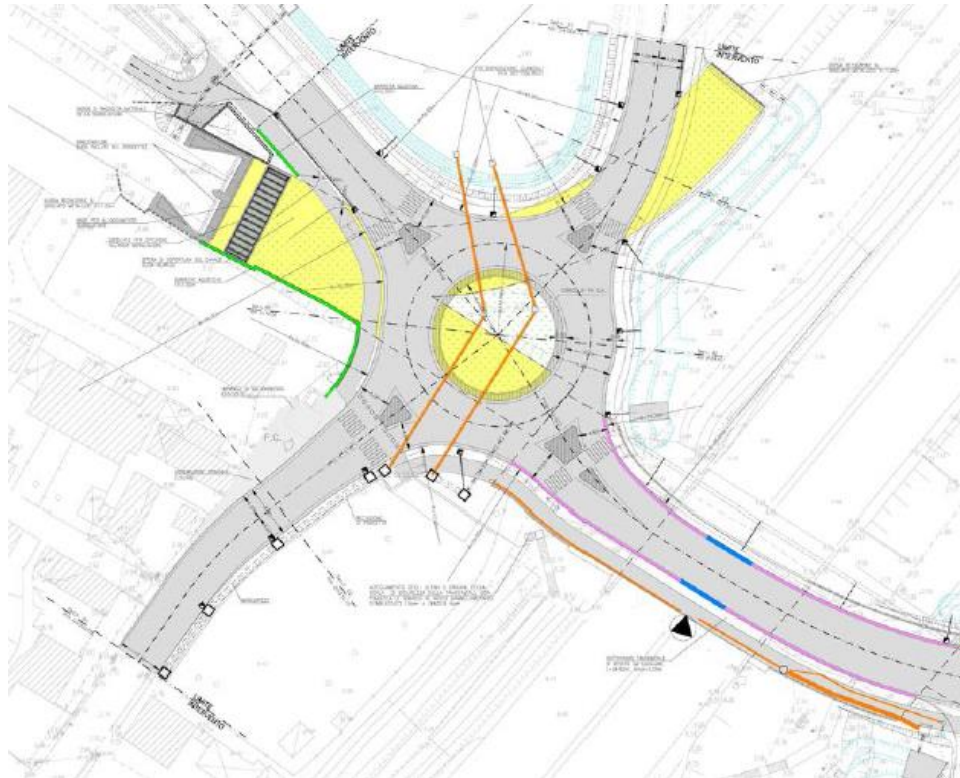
Stralcio Planimetrico rotatoria di via Gazzera Bassa
